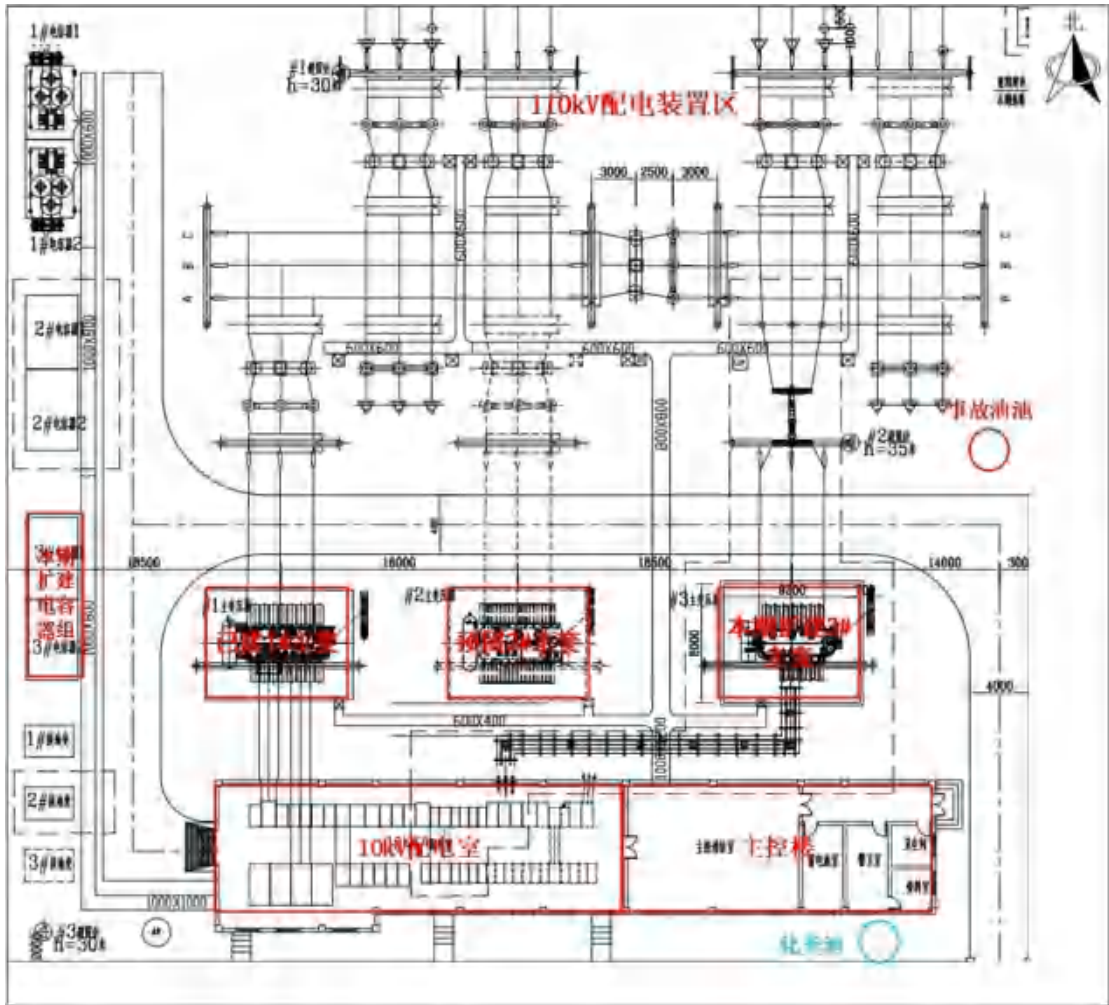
许昌市建安区庄陈 110 千伏变电站平面布置示意图
